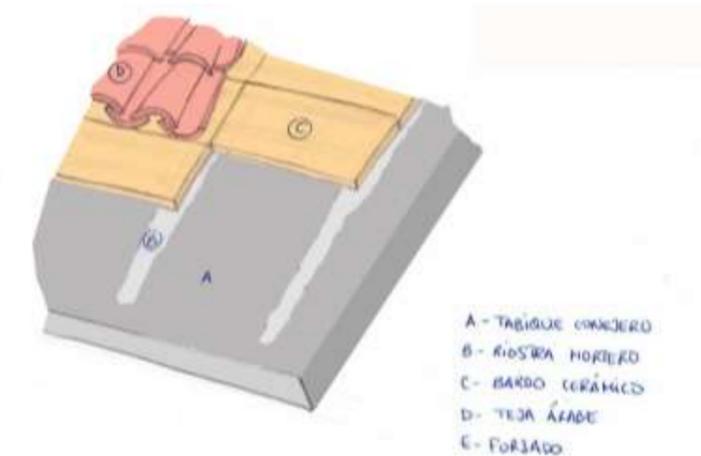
detalle cubierta TIPO 2. Elaboración propia.
